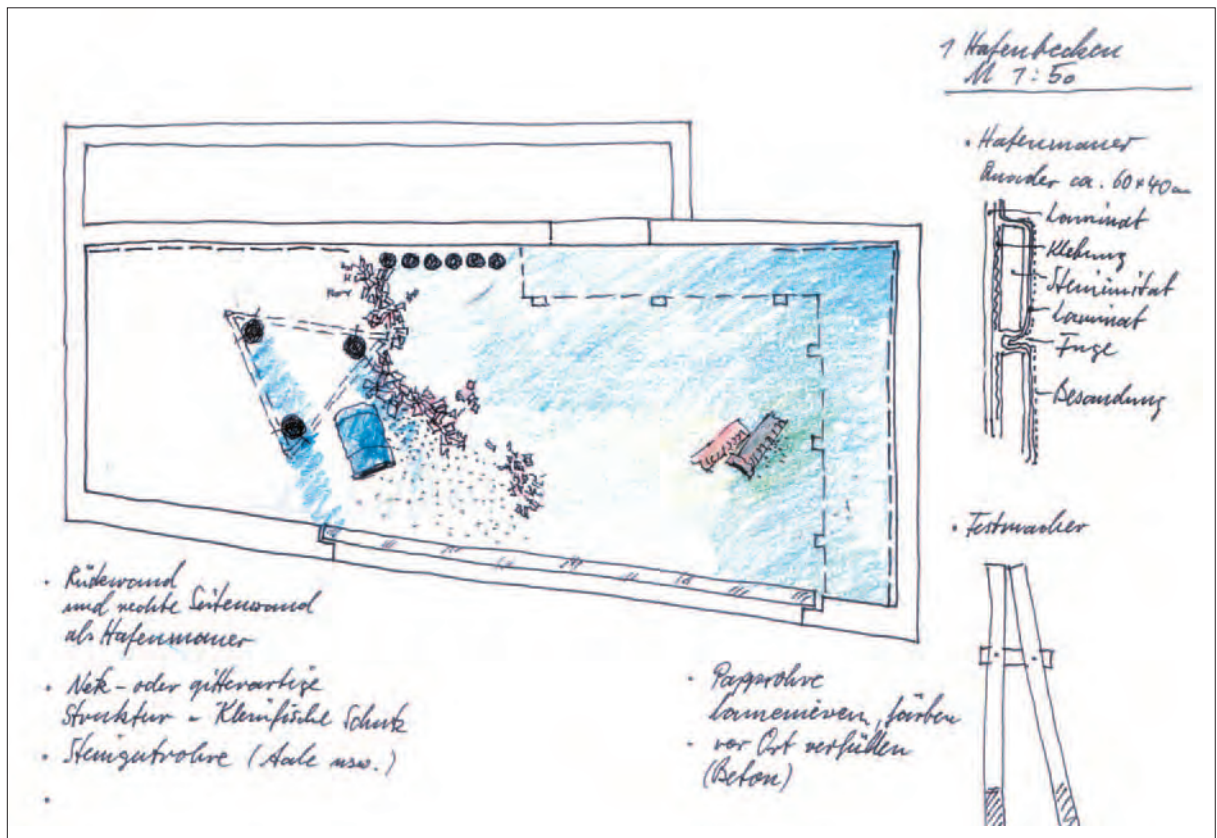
Grundrissdarstellung des Hafenbeckens. Skizze von Roland Heppert.
